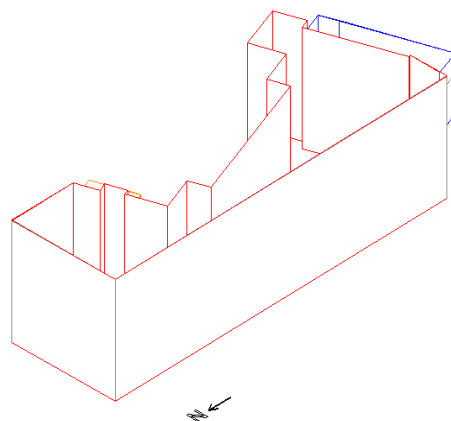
Vista em perspectiva das zonas térmicas do 1º pavimento
